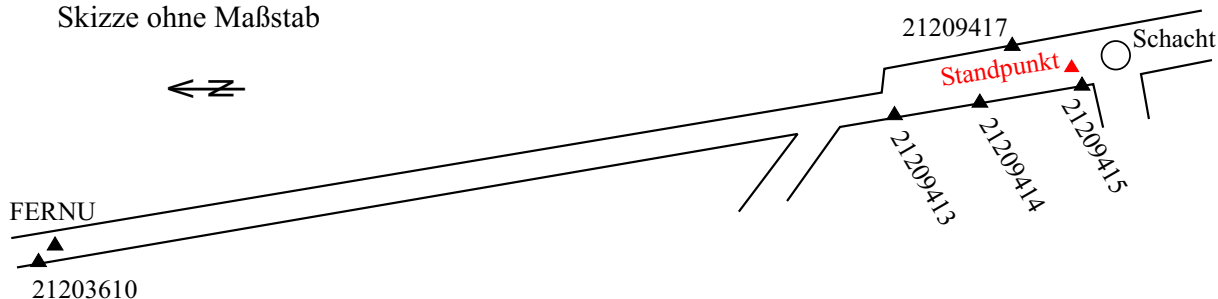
Lageplan Schachtkopf und -fuss
